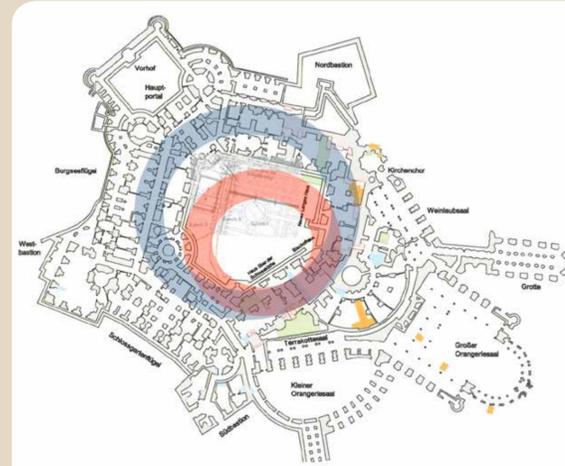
Blau gekennzeichnet: bisher bekannter bzw. vermuteter Wallverlauf (jüngerer Wall). Rot gekennzeichnet: 2014 entdeckter Wall, gebaut ab 942, verstärkt ab 965 nach Chr. Graphik: Dr. Detlef Jantzen, Plangrundlage: Torsten Dressler
